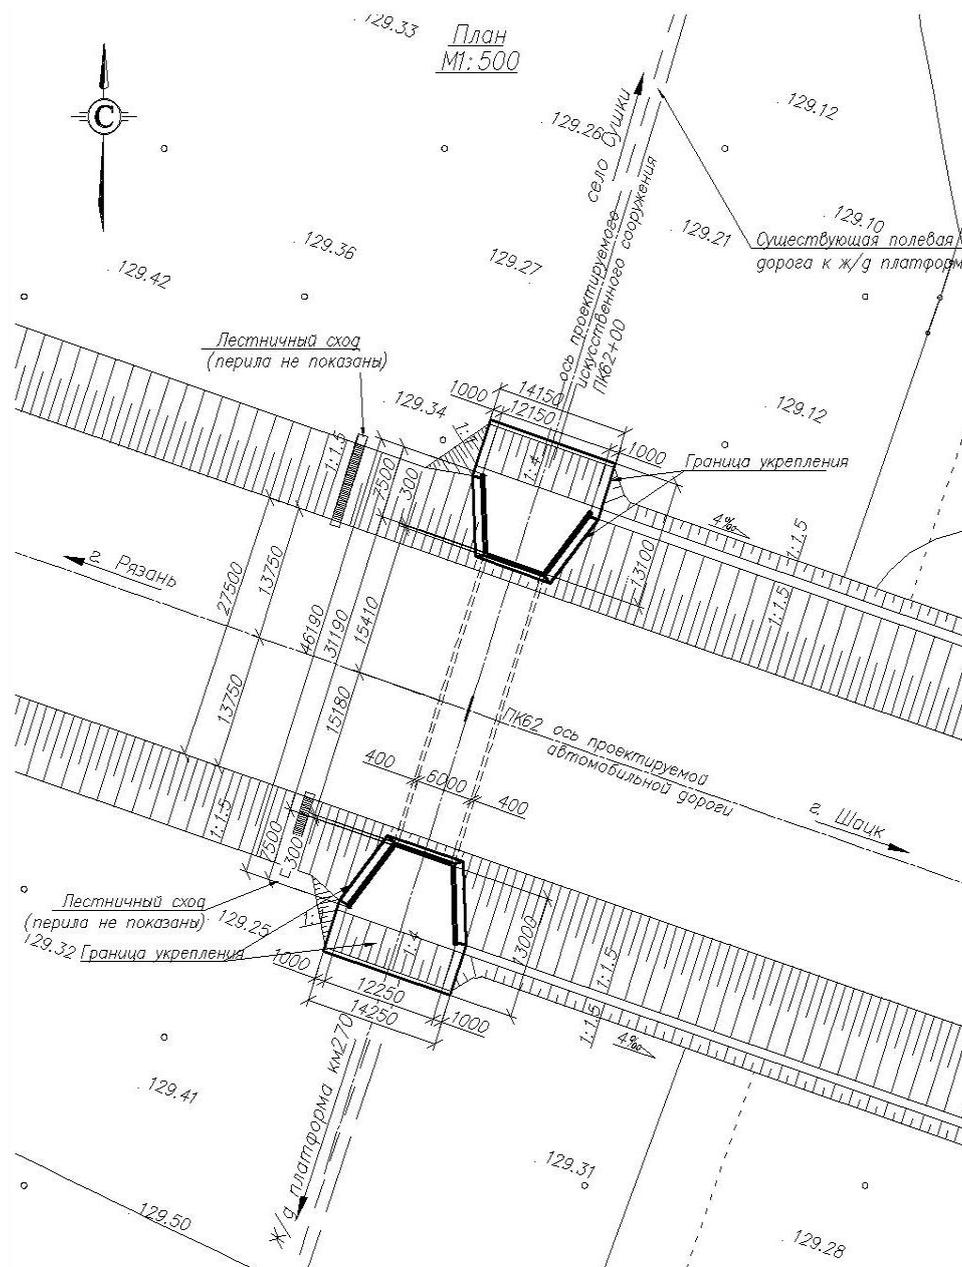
Топографический план размещения водопропускной трубы на автомобильной дороге федерального значения
